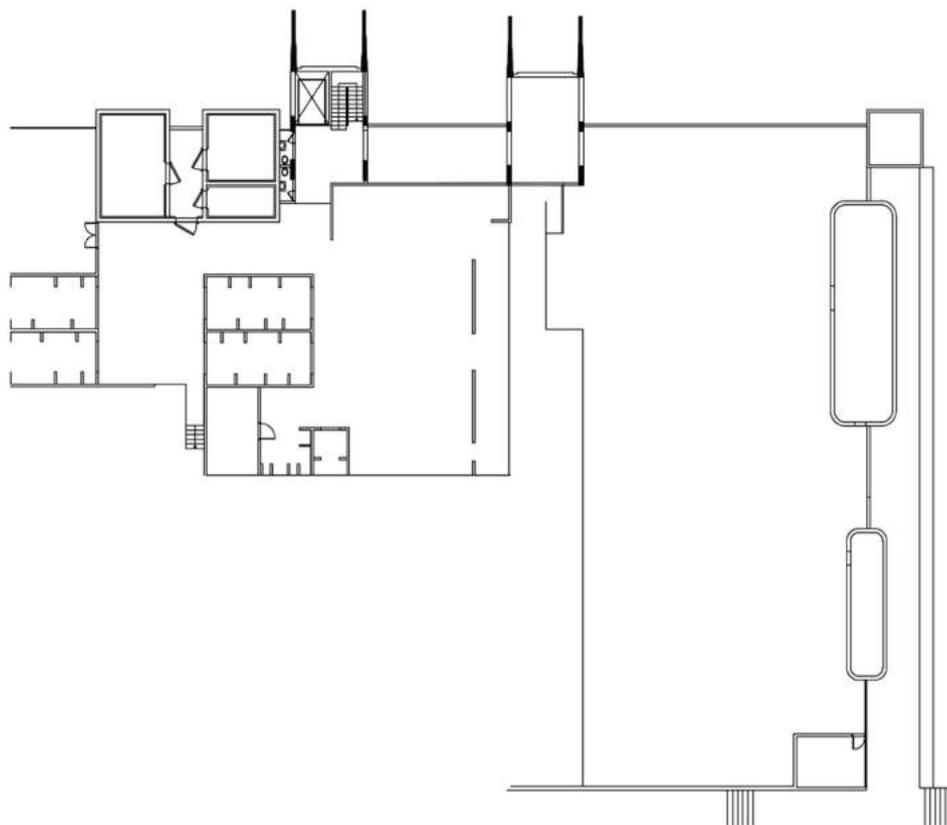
Planta da BCCL – subsolo – Montagem Autor: Dutra, P. 2020
